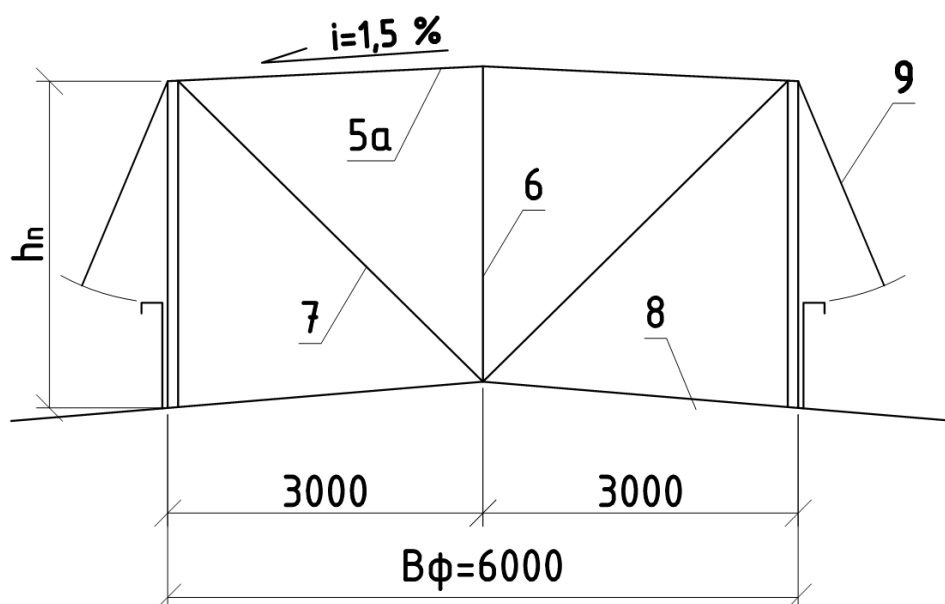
Поперечная рама фонаря: 5а - ригель из двух швеллеров; 6 - стойка из двух уголков; 7 - раскос из двух уголков; 8 - верх несущей конструкции покрытия; 9 - остекленный переплет фонаря.
